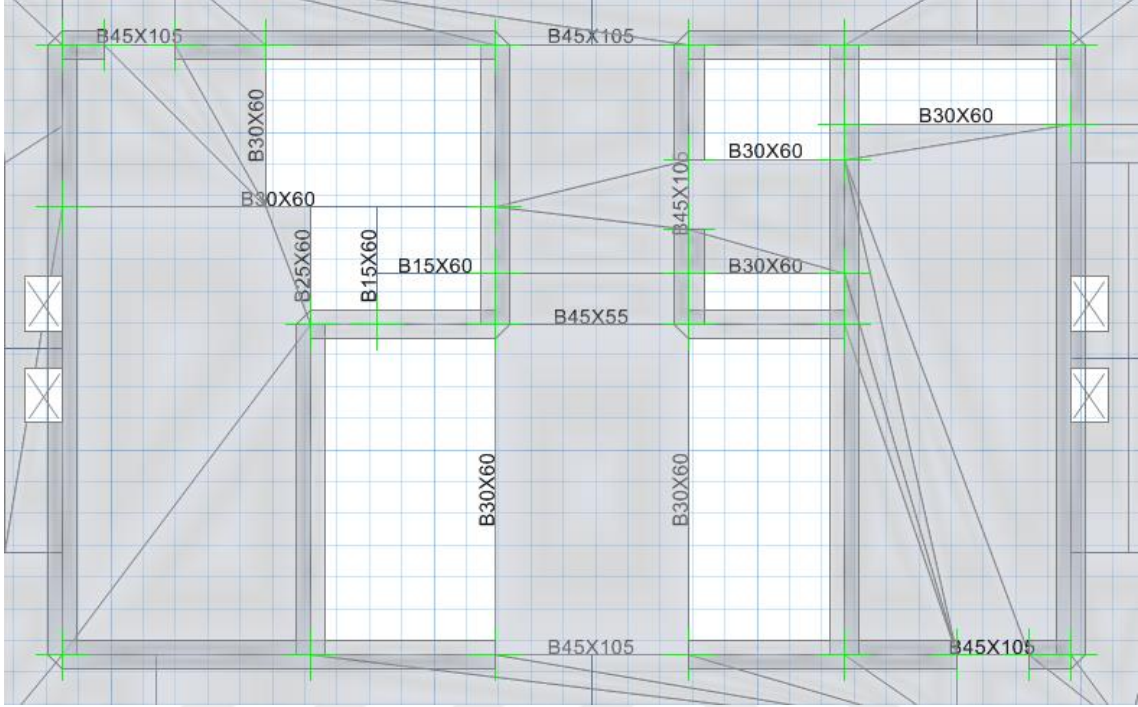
Analiz yapılan katın boşluklu döşeme kalıp planı
